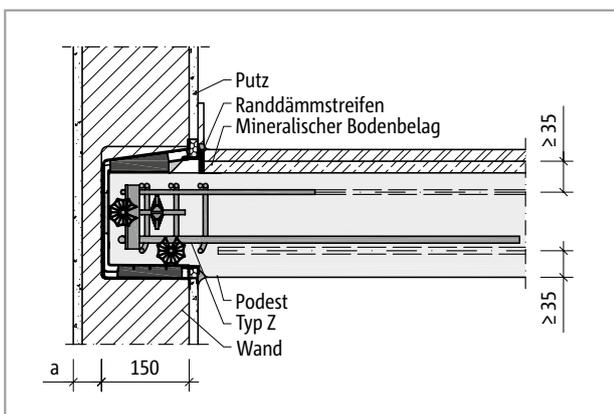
Schöck Tronsole® Typ Z: Brandschutzausführung
